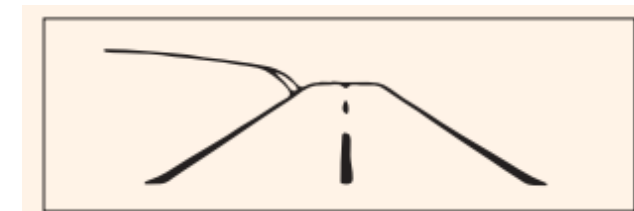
Situaciones a evitar en la coordinación planta alzado (VI)
